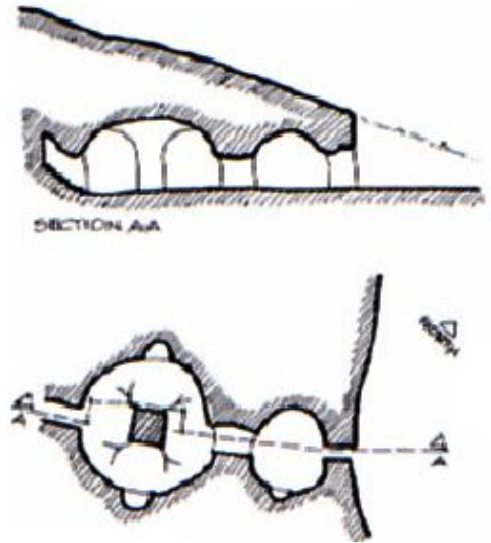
٢٤): مسقط أفقي وقطاع رأسي لأحد الكهوف الأسترالية (Golany,1983,p41).
